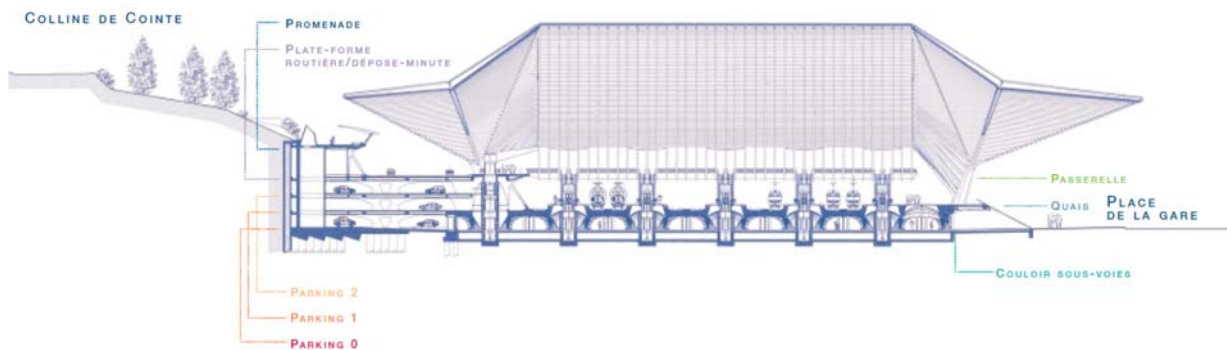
Coupe transversale de la gare des Guillemins (source : SNCB, 2000).
